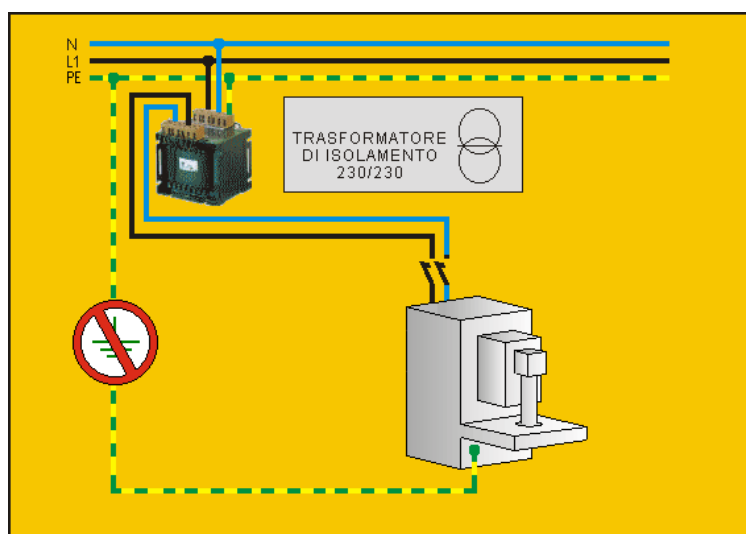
E' proibito il collegamento a terra nei sistemi di alimentazione che attuano la protezione per separazione elettrica
